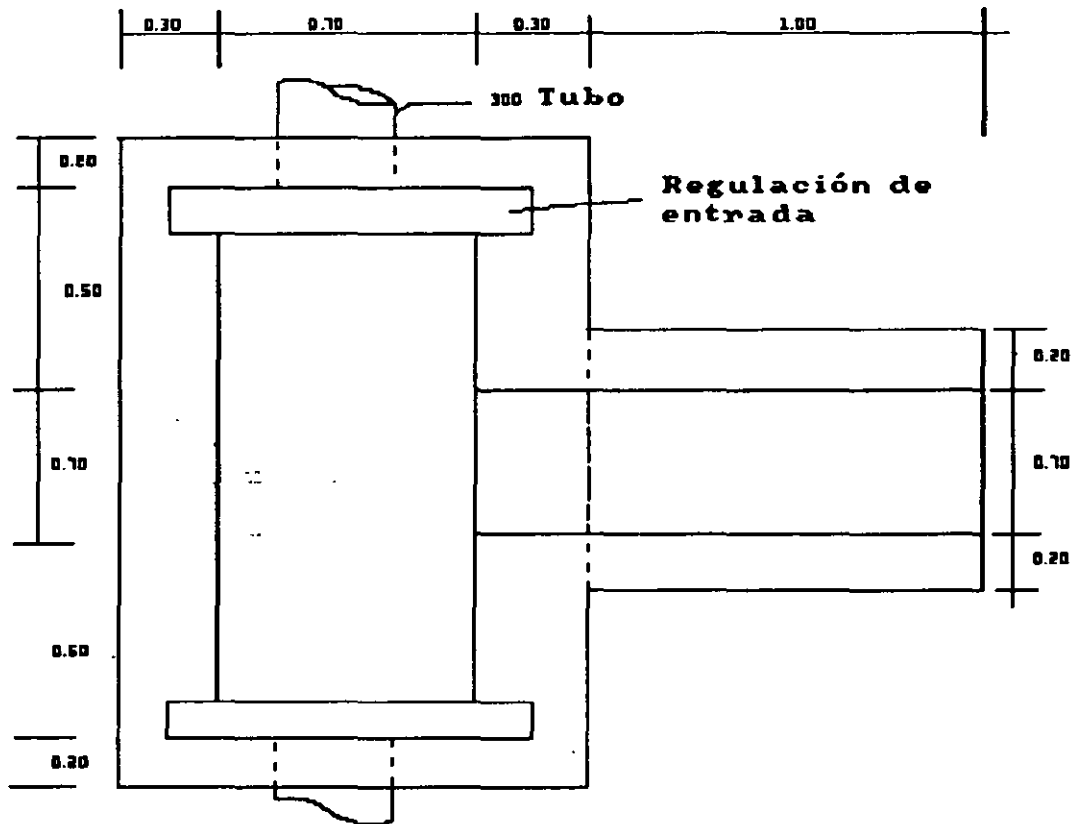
Detalle de la caja de entrada a lagunas anaeróbicas. Vista en planta.
